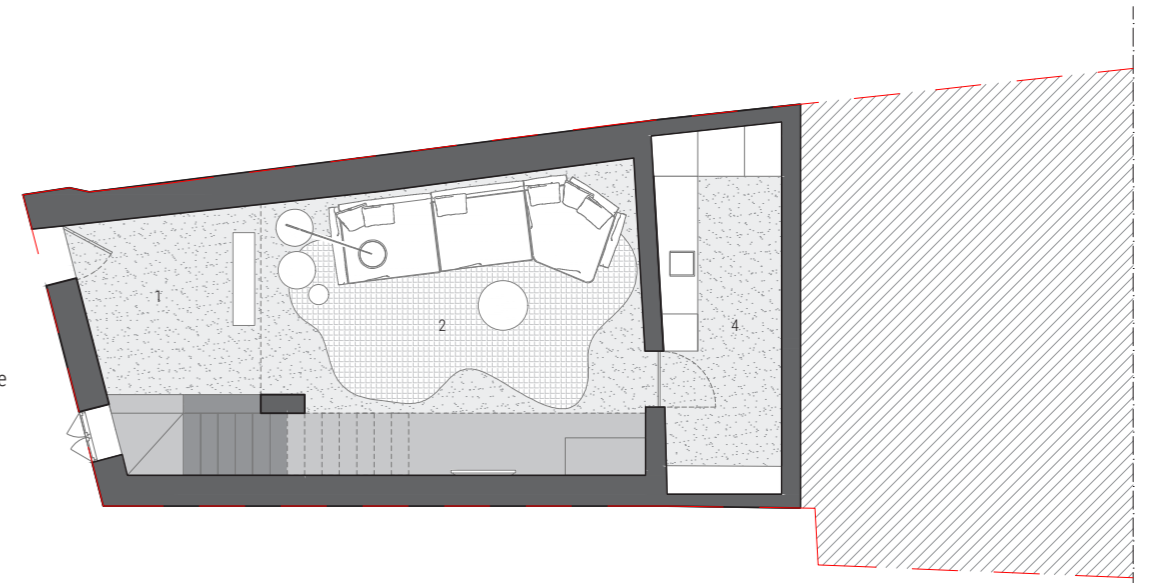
Planta do Piso 2 do projeto de Arquitetura.
